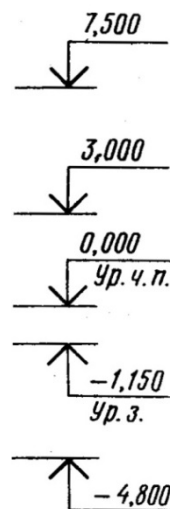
Высотные отметки на фасаде и разрезе
